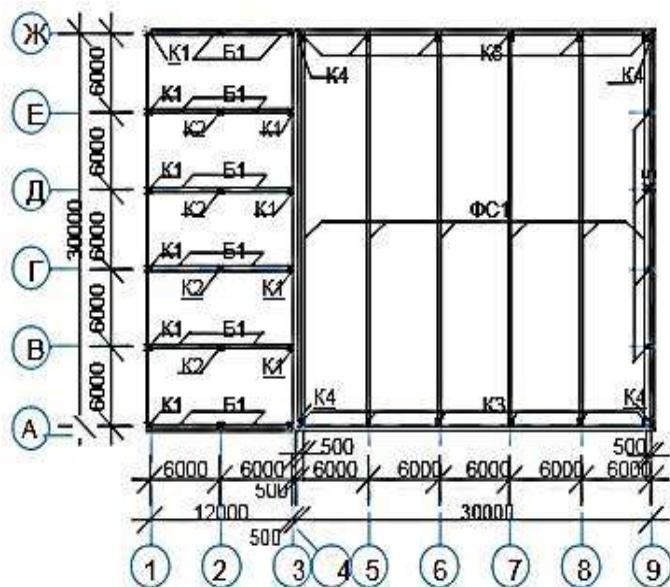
Схема расположения колонн, балок и ферм покрытия
